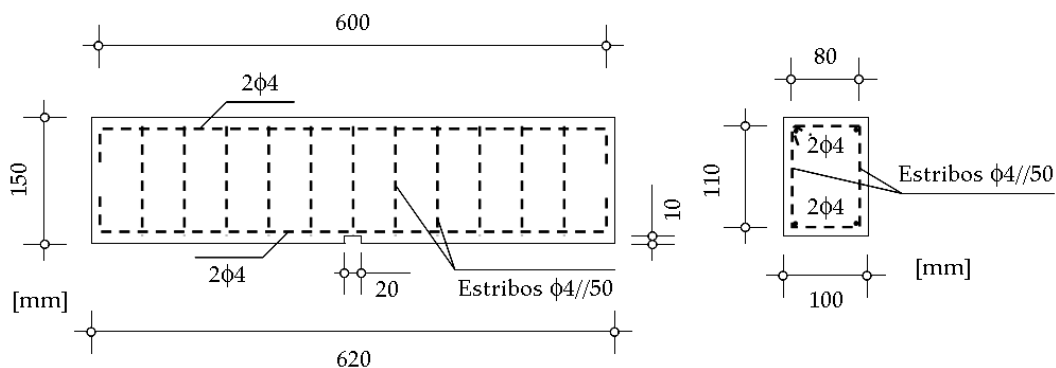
Pormenor das armaduras das vigas de secção rectangular.
